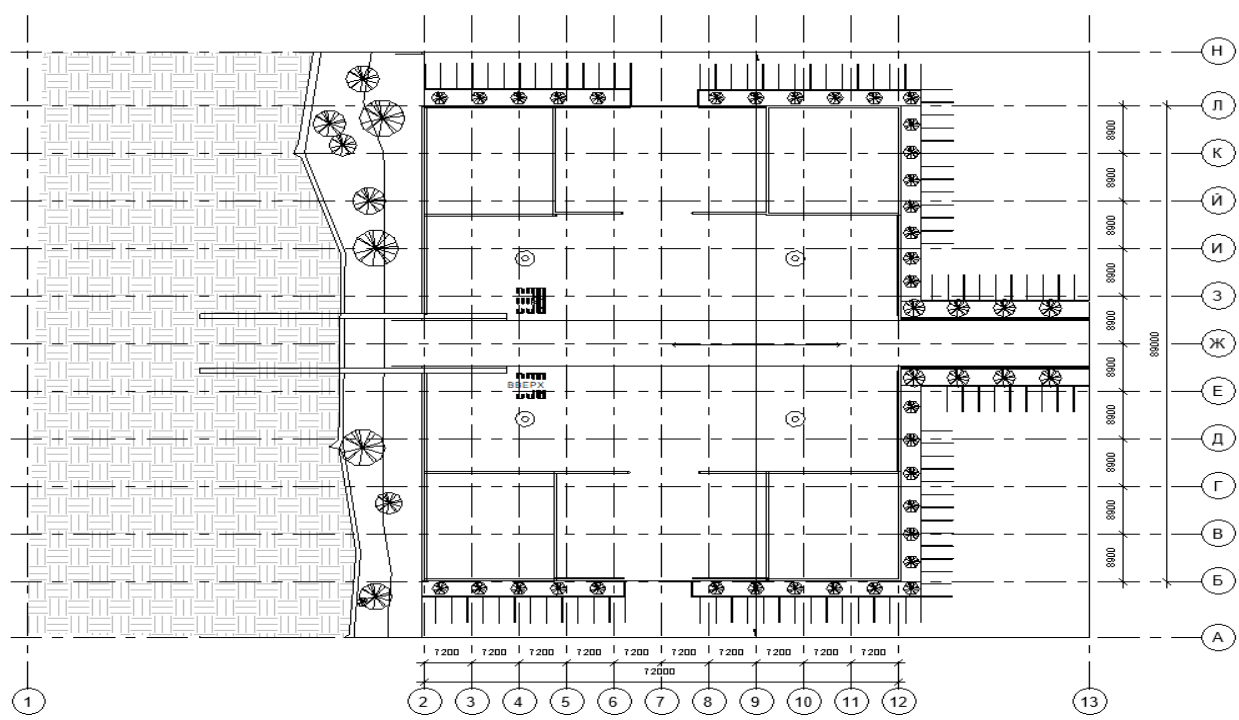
План в осях А-Н, 1-13 на отм. 4.700
